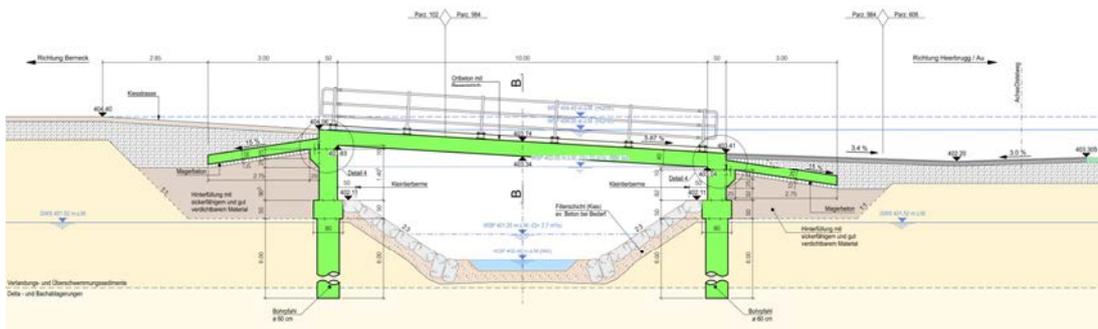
Vertikale Linienführung Brücke Wisenstrasse, Ächeli
